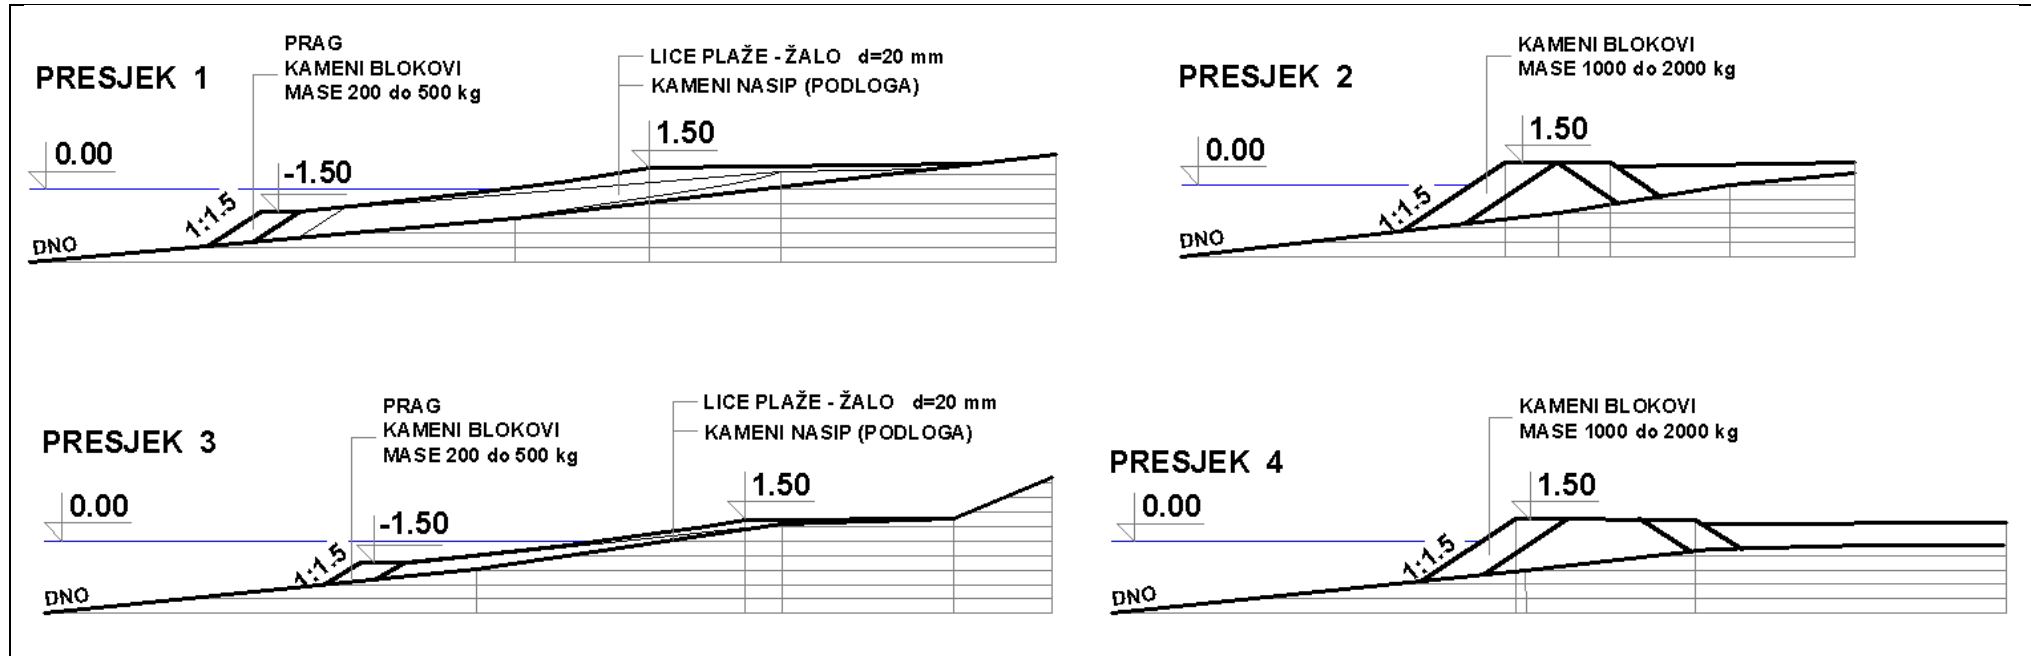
Rješenje rekonstrukcije i prihrane plaže – Varijanta C
